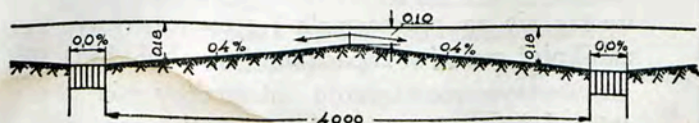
Wyrównująca rama żelbetowa tjako oparcie dla pokrywy.
